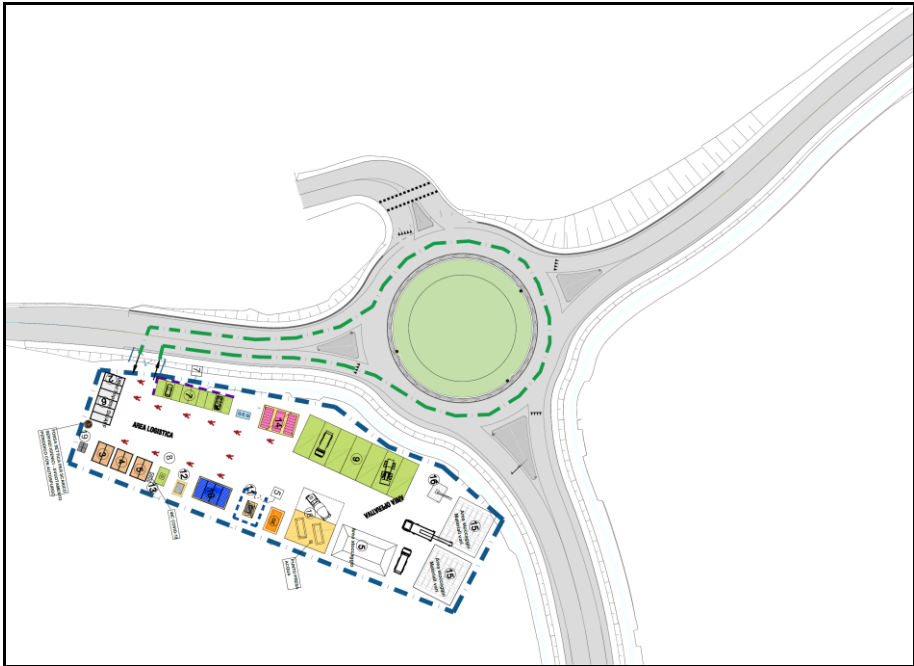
elaborati progettuali (planimetria generale cantiere, campo base 1)
